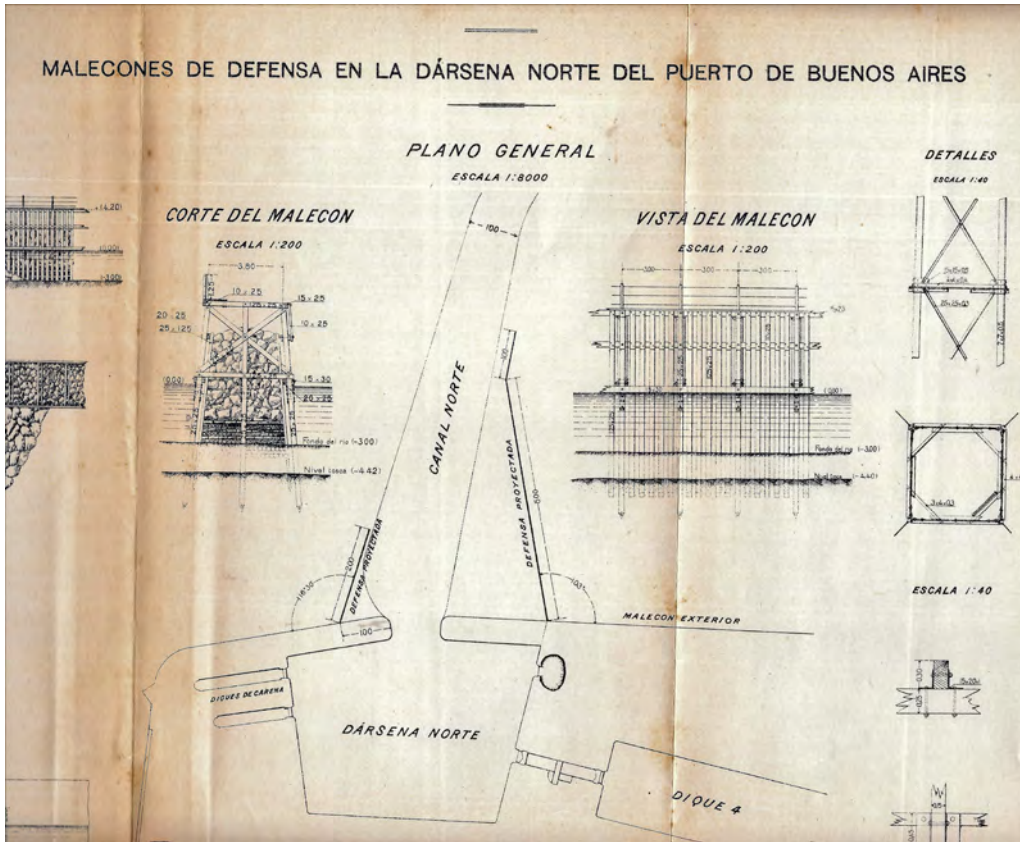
Sistema constructivo de la Dársena Norte mediante postes clavados bajo el fondo del río. En el círculo la Dársena 1 (Archivo ex Ministerio de Obras Públicas, CEDIAP).
